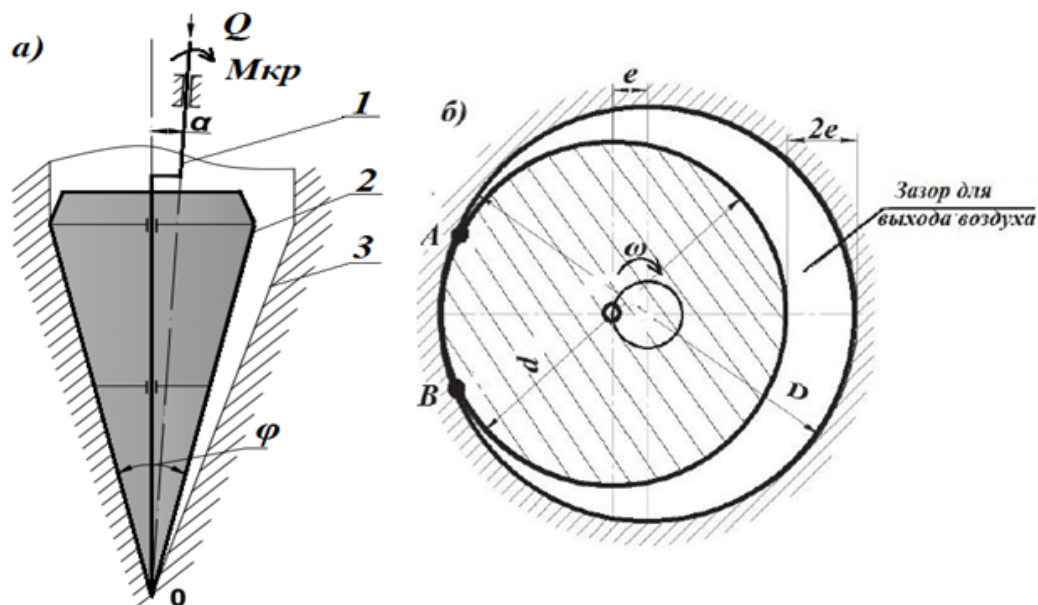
Схема устройства для раскатки котлованов: а – вид сбоку, б – вид сверху;
